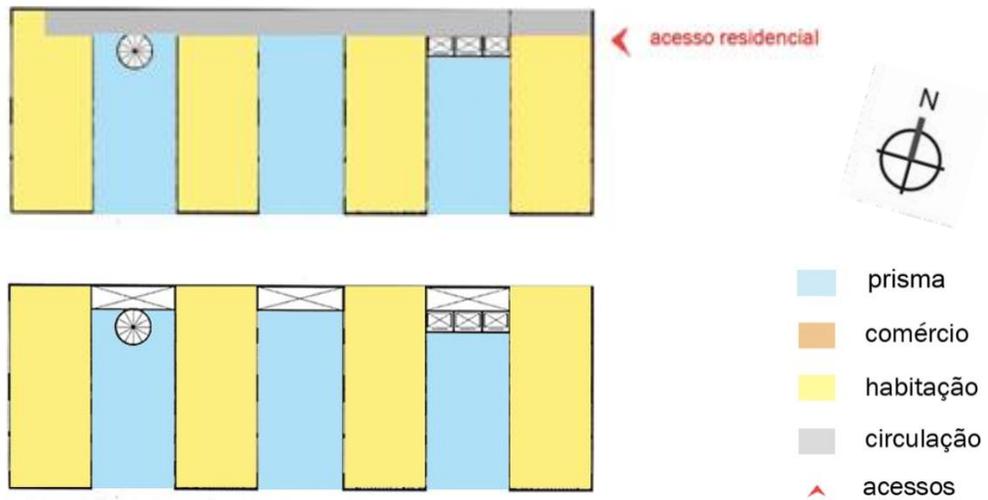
Planta esquemática trabalhada graficamente. Fonte: A Promoção Privada de Habitação Econômica e a Arquitetura Moderna 1930 - 1964. 2002. Data: 05/2010.
